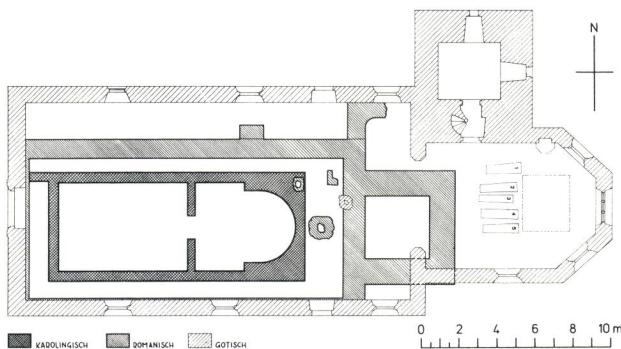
Uznach. Kath. Heiligkreuzkirche. Bautappenplan mit den Grundrissen der Vorgängerbauten: Romanisch (12. Jh.), karolingisch (9. Jh.). Nach B. Frei bzw. B. Anderes.
